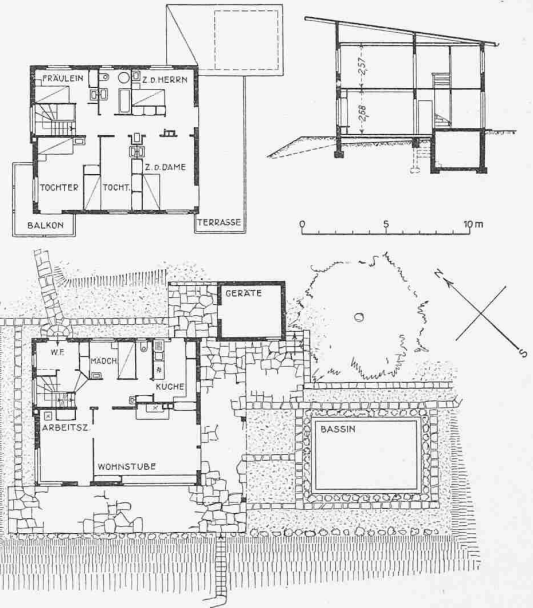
Grundrisse und Schnitt, Masstab 1 : 400.
